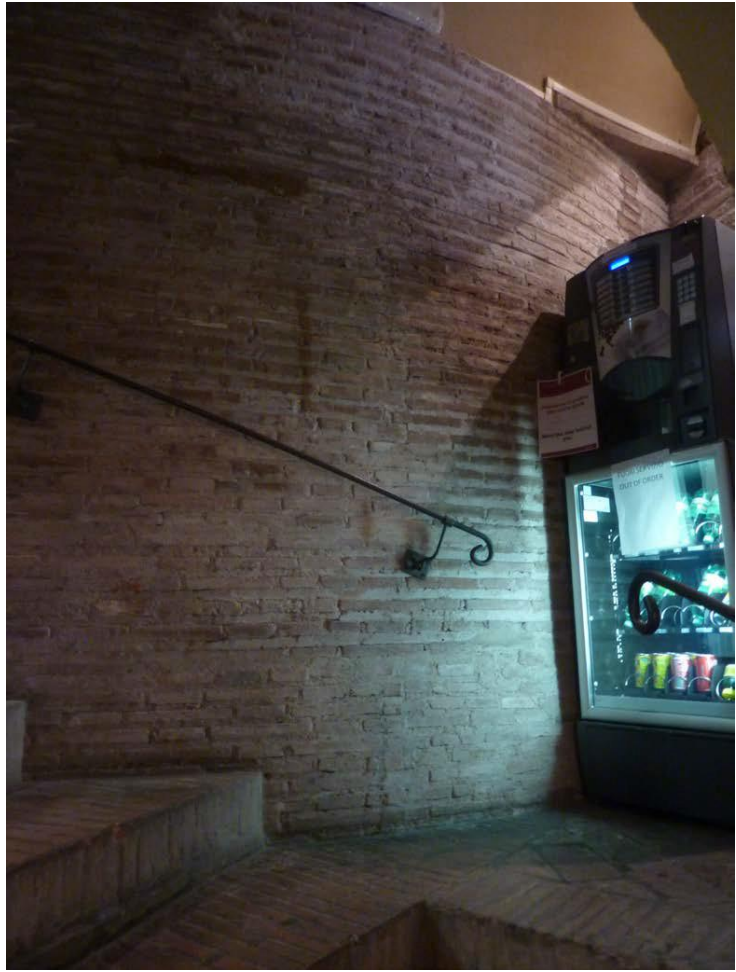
Prospetto SS6e. Foto D'Ippolito.
